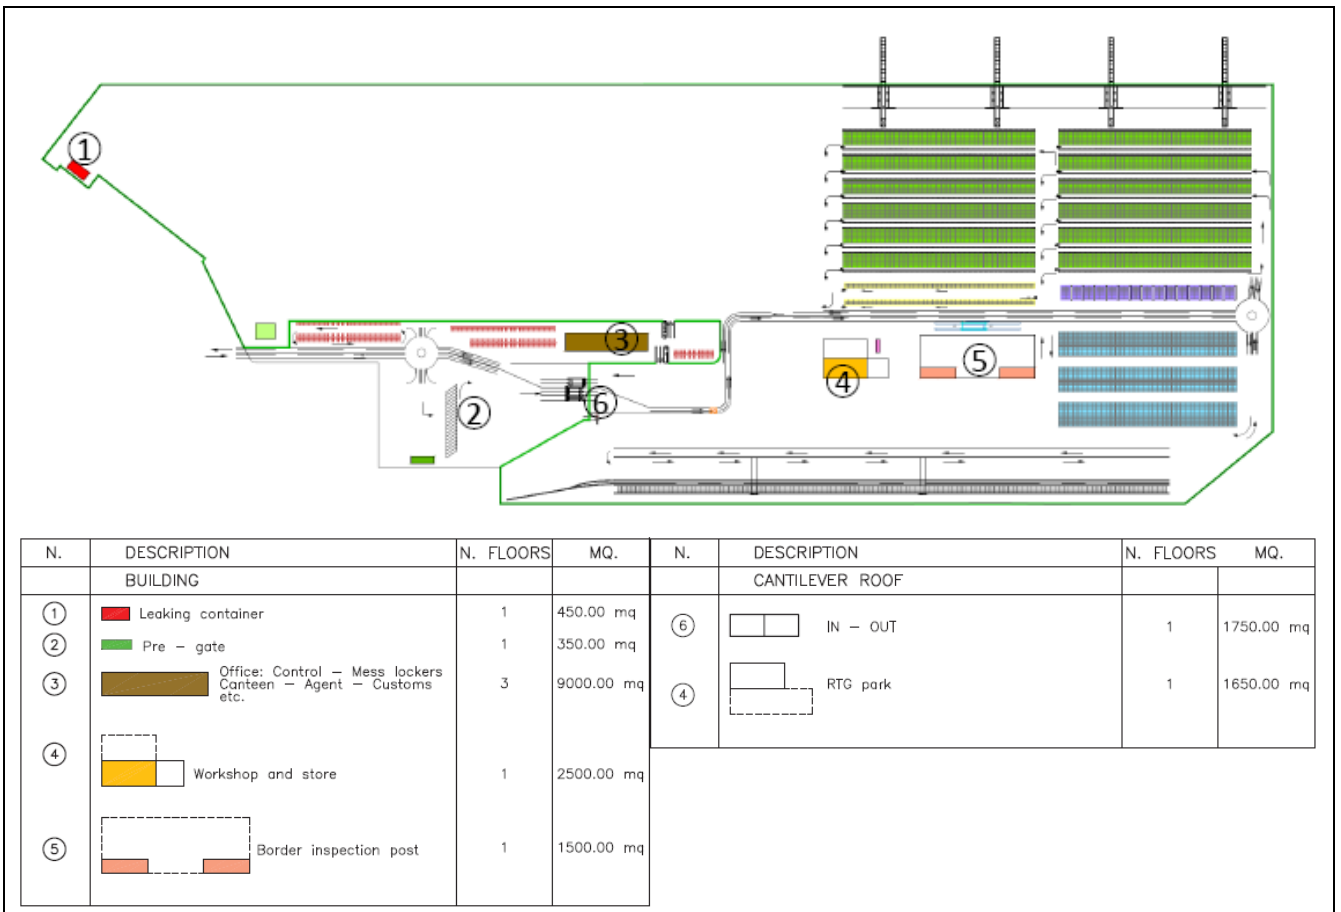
Planimetria terminal convenzionale e indicazione strutture principali
